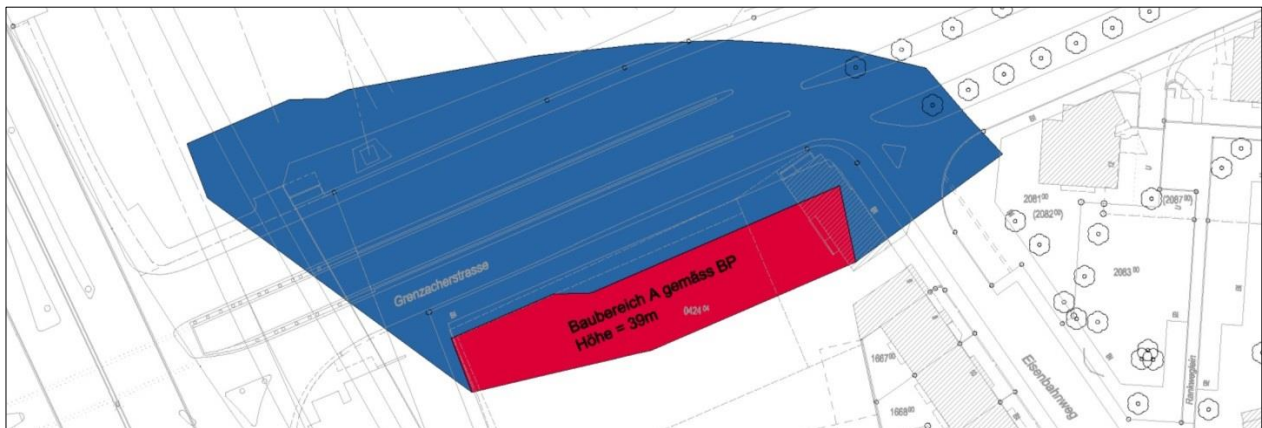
2-Stunden Schatten. Quelle: Planungsamt BS (Kein Massstab, Plan genordet)
